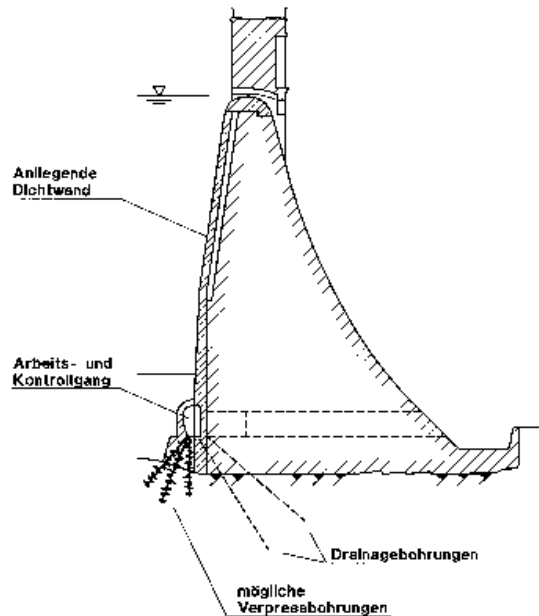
Ältere Sanierungsvariante mit einer Beton-Vorsatzschale
